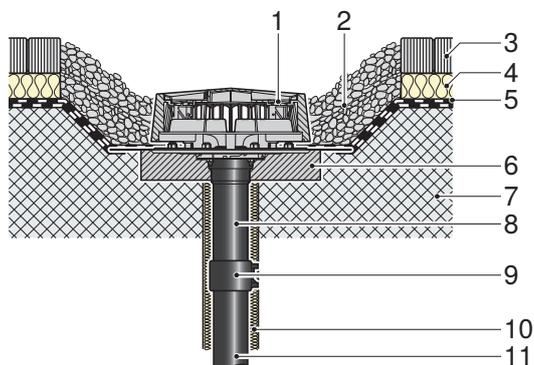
Монтаж на неизолированной жесткой кровле с битумным кровельным покрытием, выдерживающим вес людей
